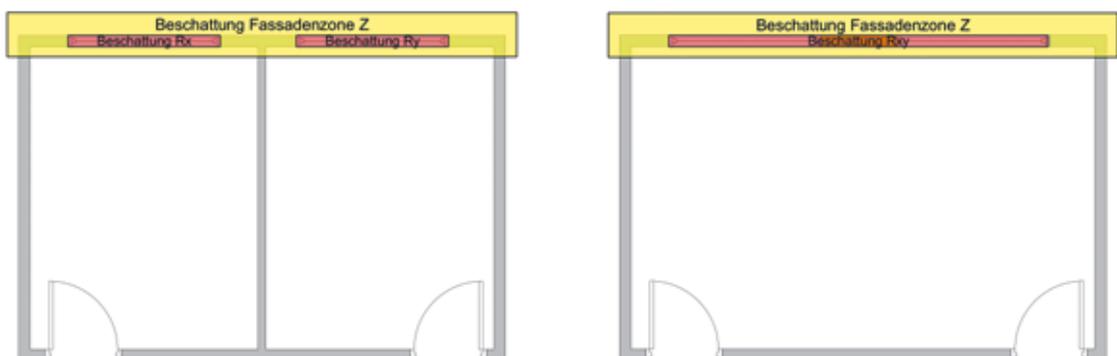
Zonenplanung Beschattung, nur auf Stockwerksebene betrachtet. (Quelle: ahochn)
